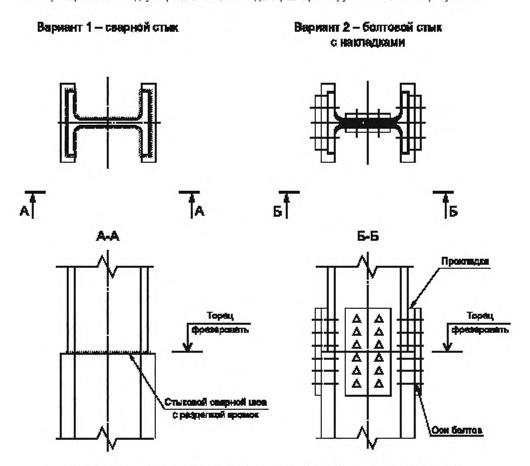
Примеры стыковки двутавров типа К или Ш одной размерной группы
